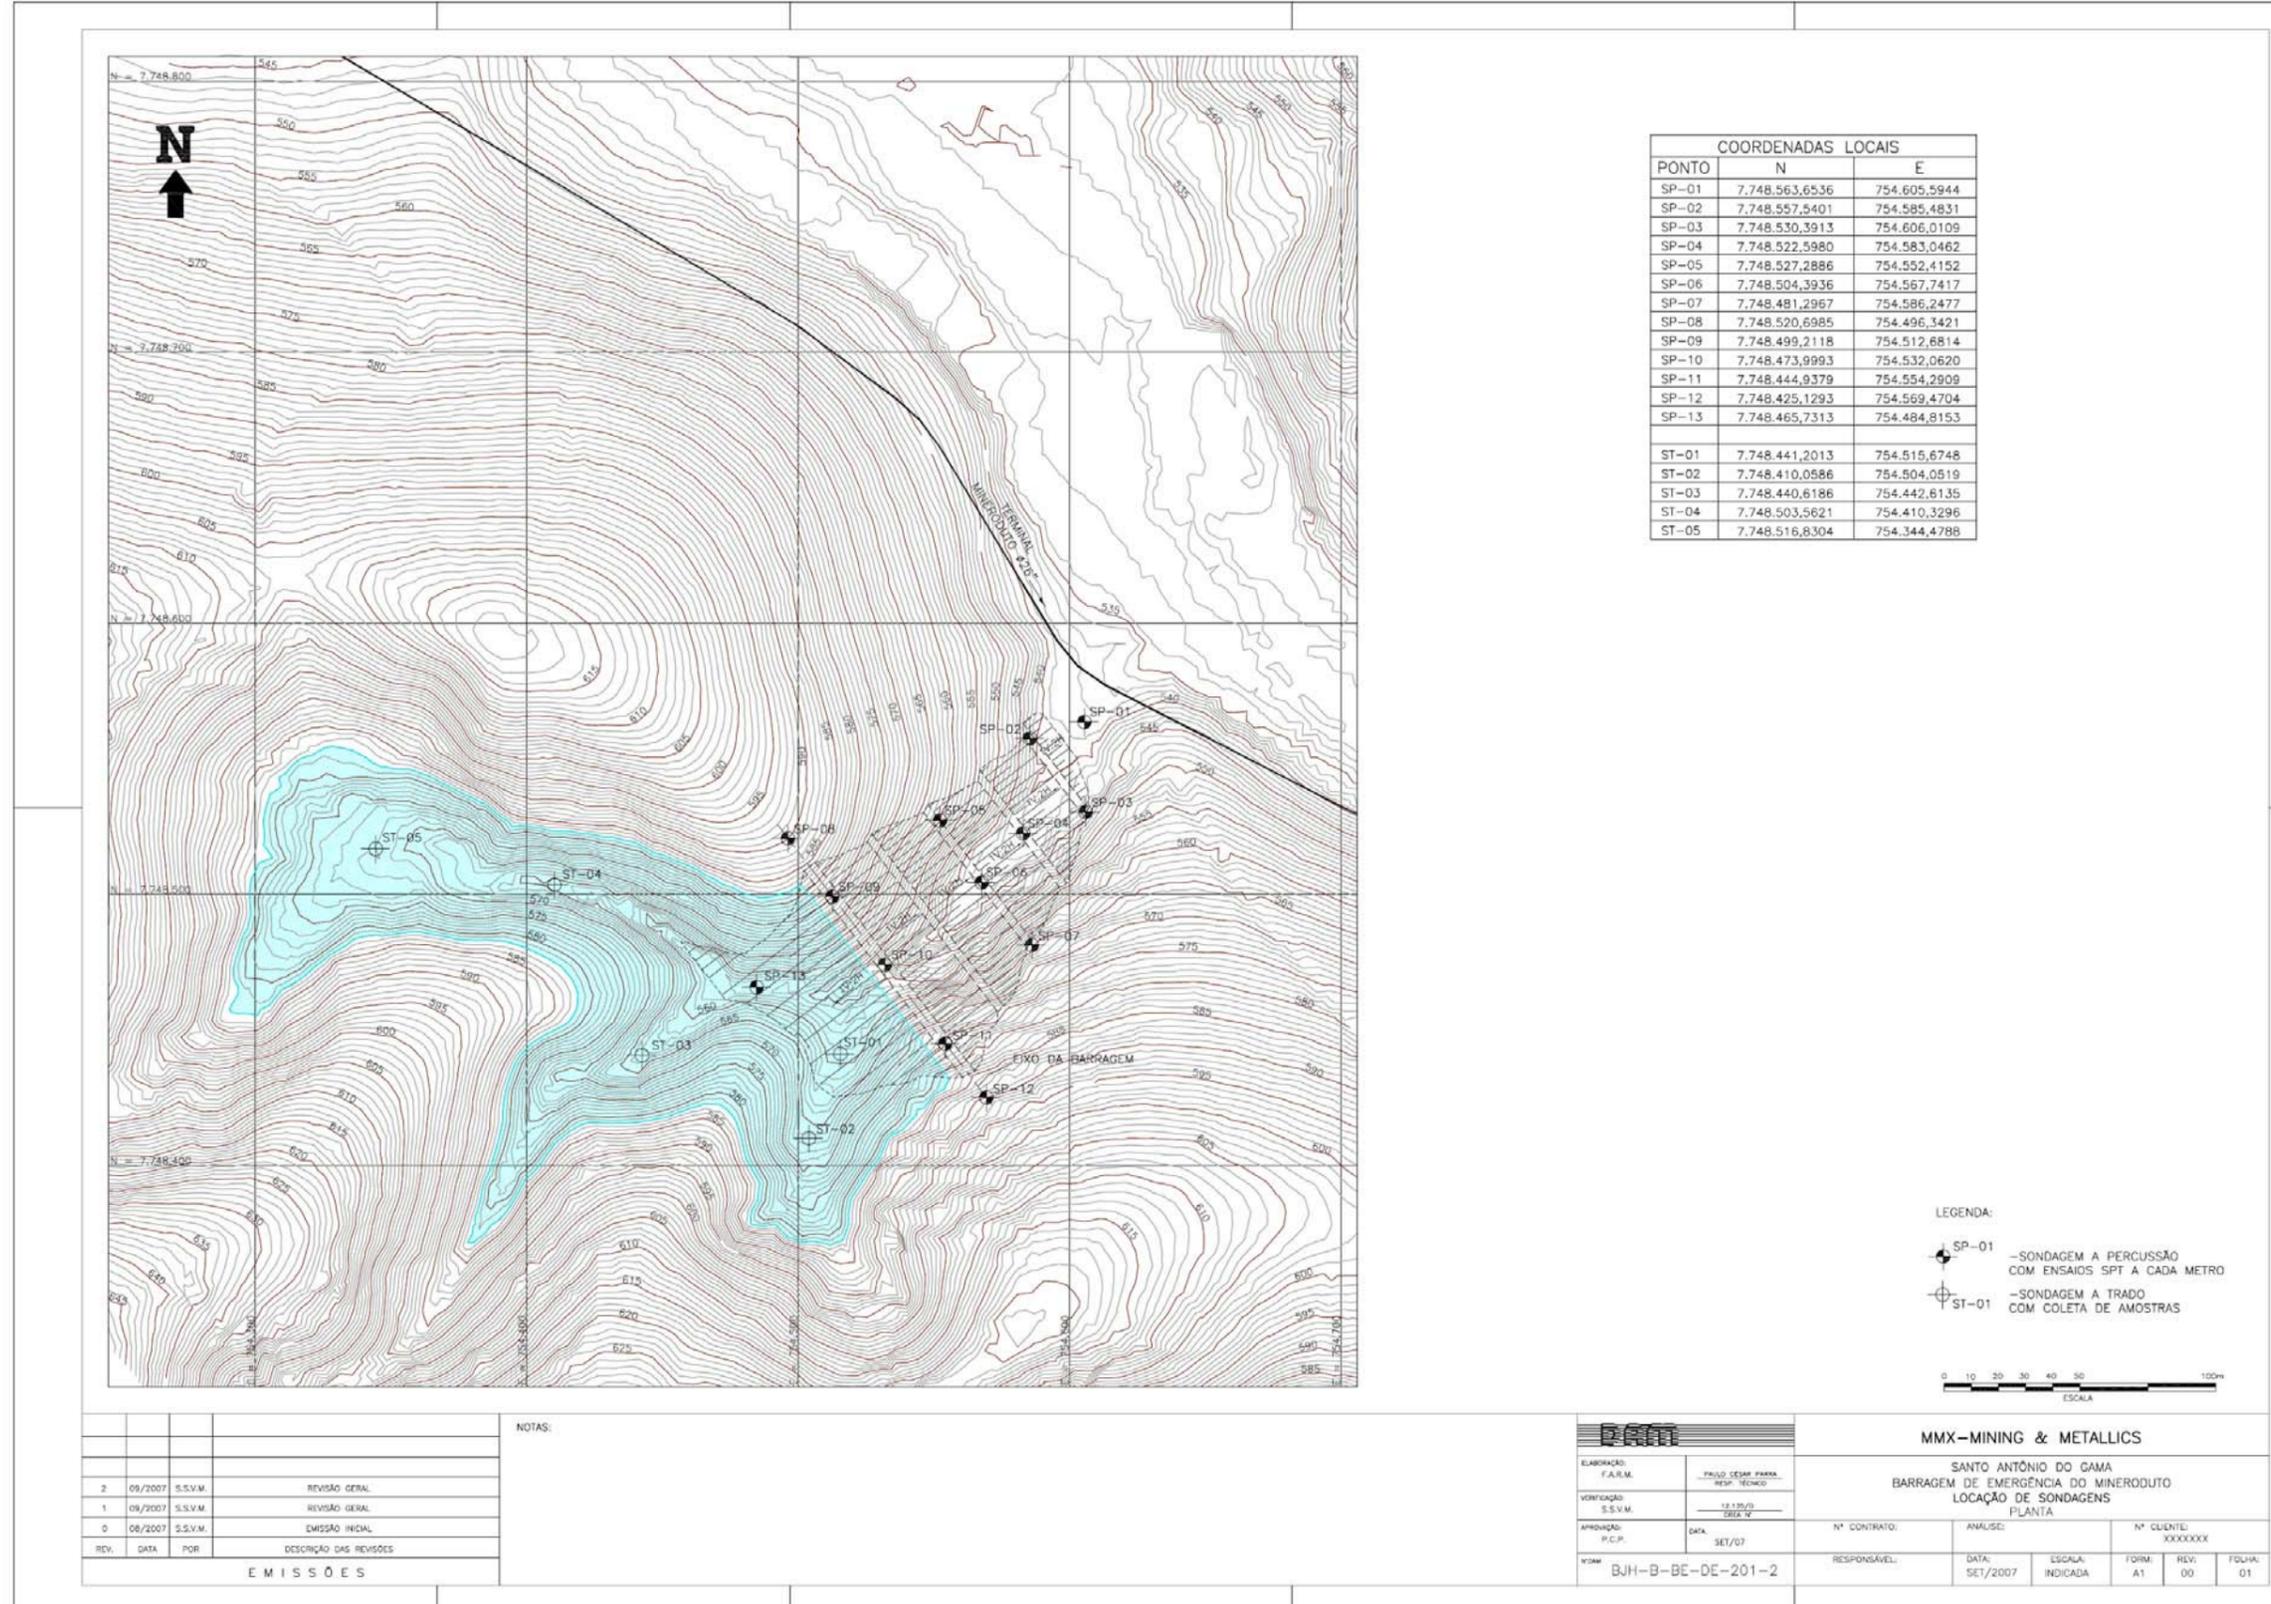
Planta baixa do barramento e do reservatório
